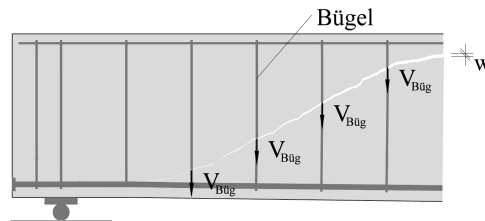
Kritischer Schubriss im schubbewehrten Stahlbetonträger
